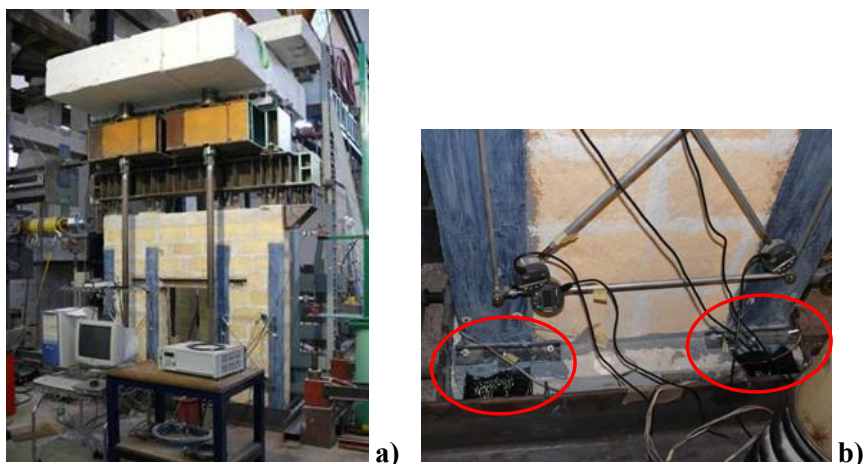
Parete rinforzata a); ancoraggi inferiori delle strisce di rinforzo b)
